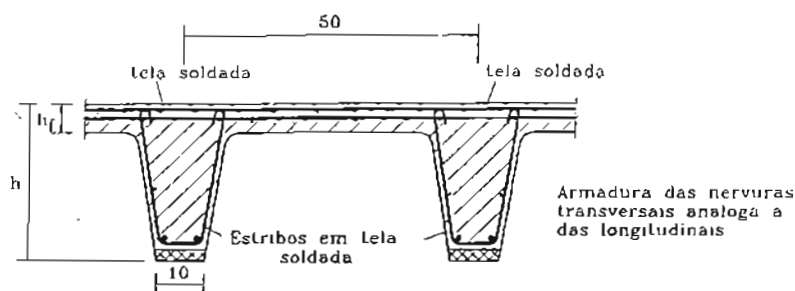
Distribuição de armaduras na lajes nervuradas
